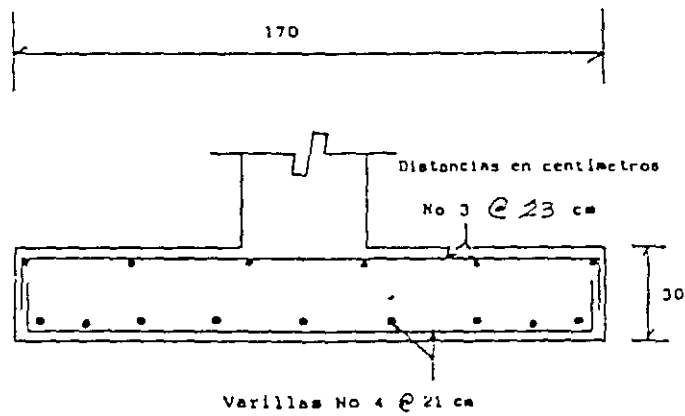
CARACTERÍSTICAS ESTRUCTURALES DE LA ZAPATA (EJEMPLO 5.6)
